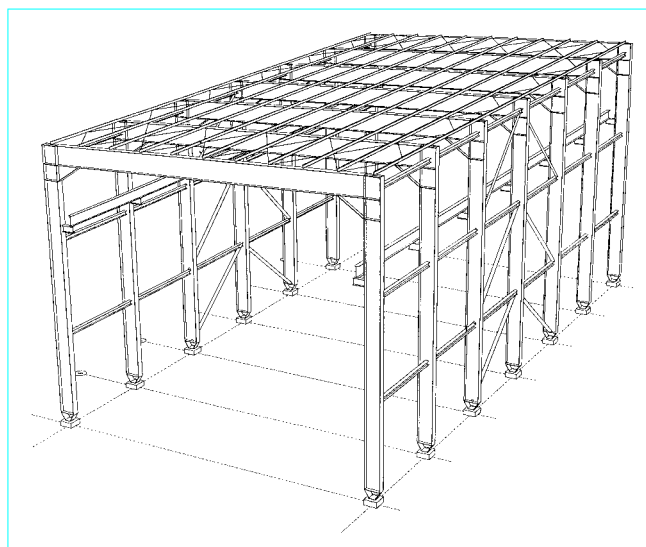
Exemple d'ossature métallique d'une halle industrielle
